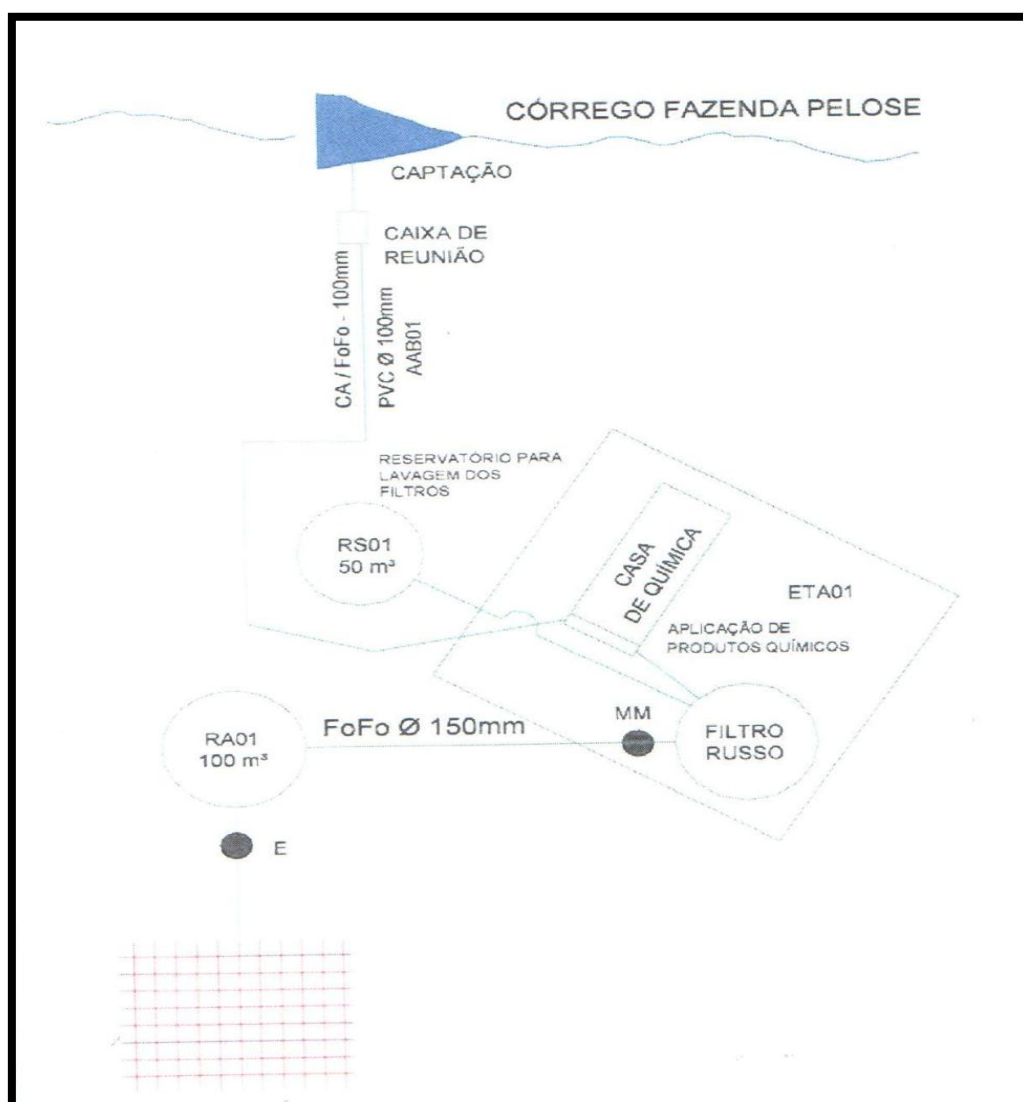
Croqui abastecimento de água bairro Campestrinho
